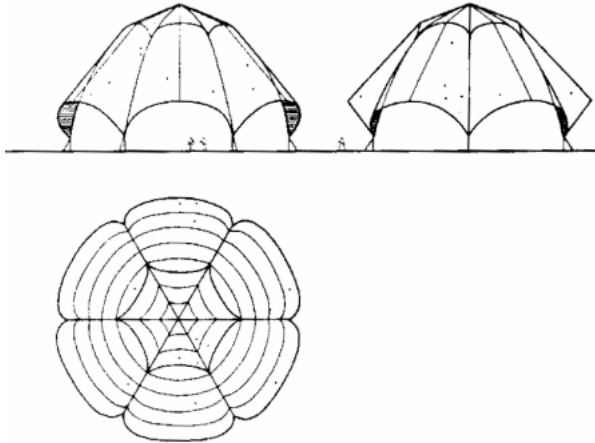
Шатрове покриття: план, фасади, загальний вид
